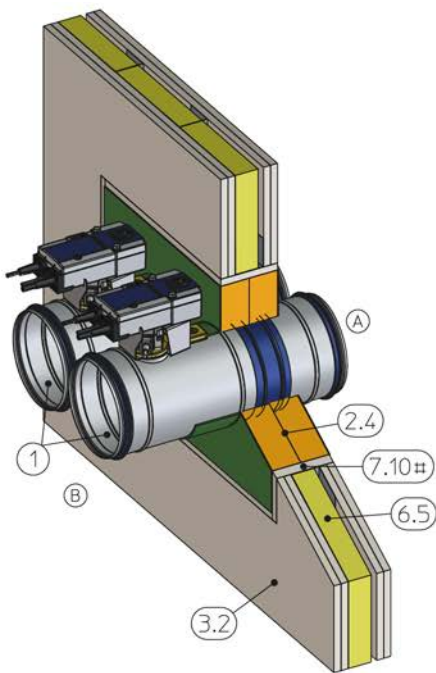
Монтаж в легкой перегородке с противопожарной плитой, без применения строительного раствора
